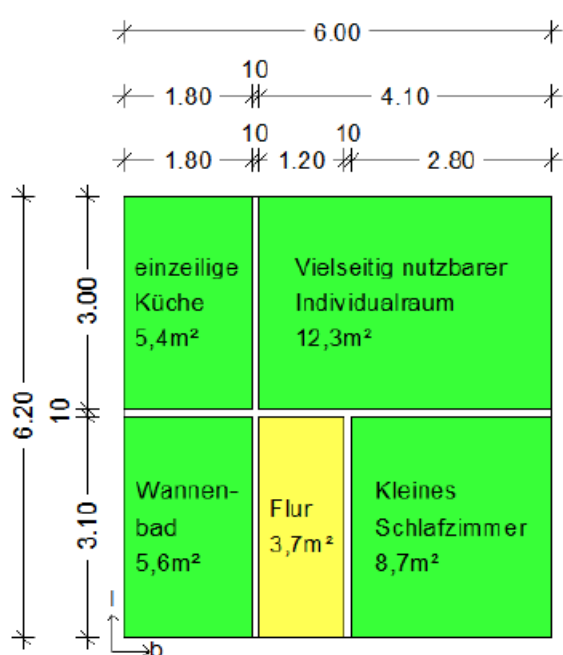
Grundriss 1 (6 m bis 8 m)
